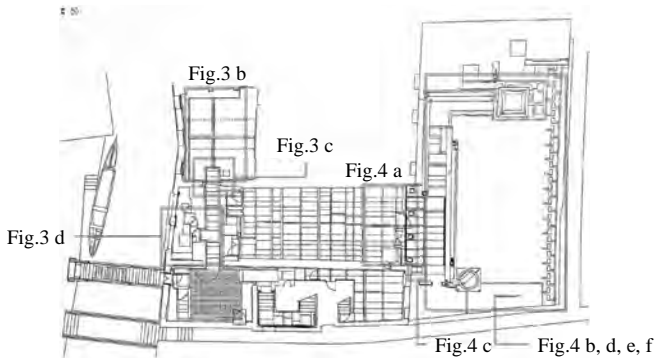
Fondazione Querini Stampalia の平面図 (文献3)から引用・改変)
